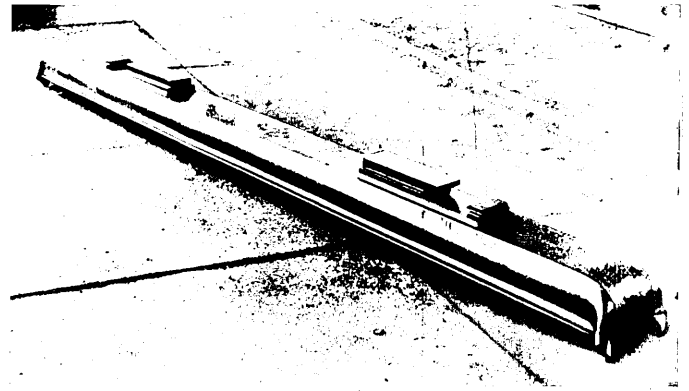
Neue Schwellenform mit aufgeschweißten Gleitstählen.
